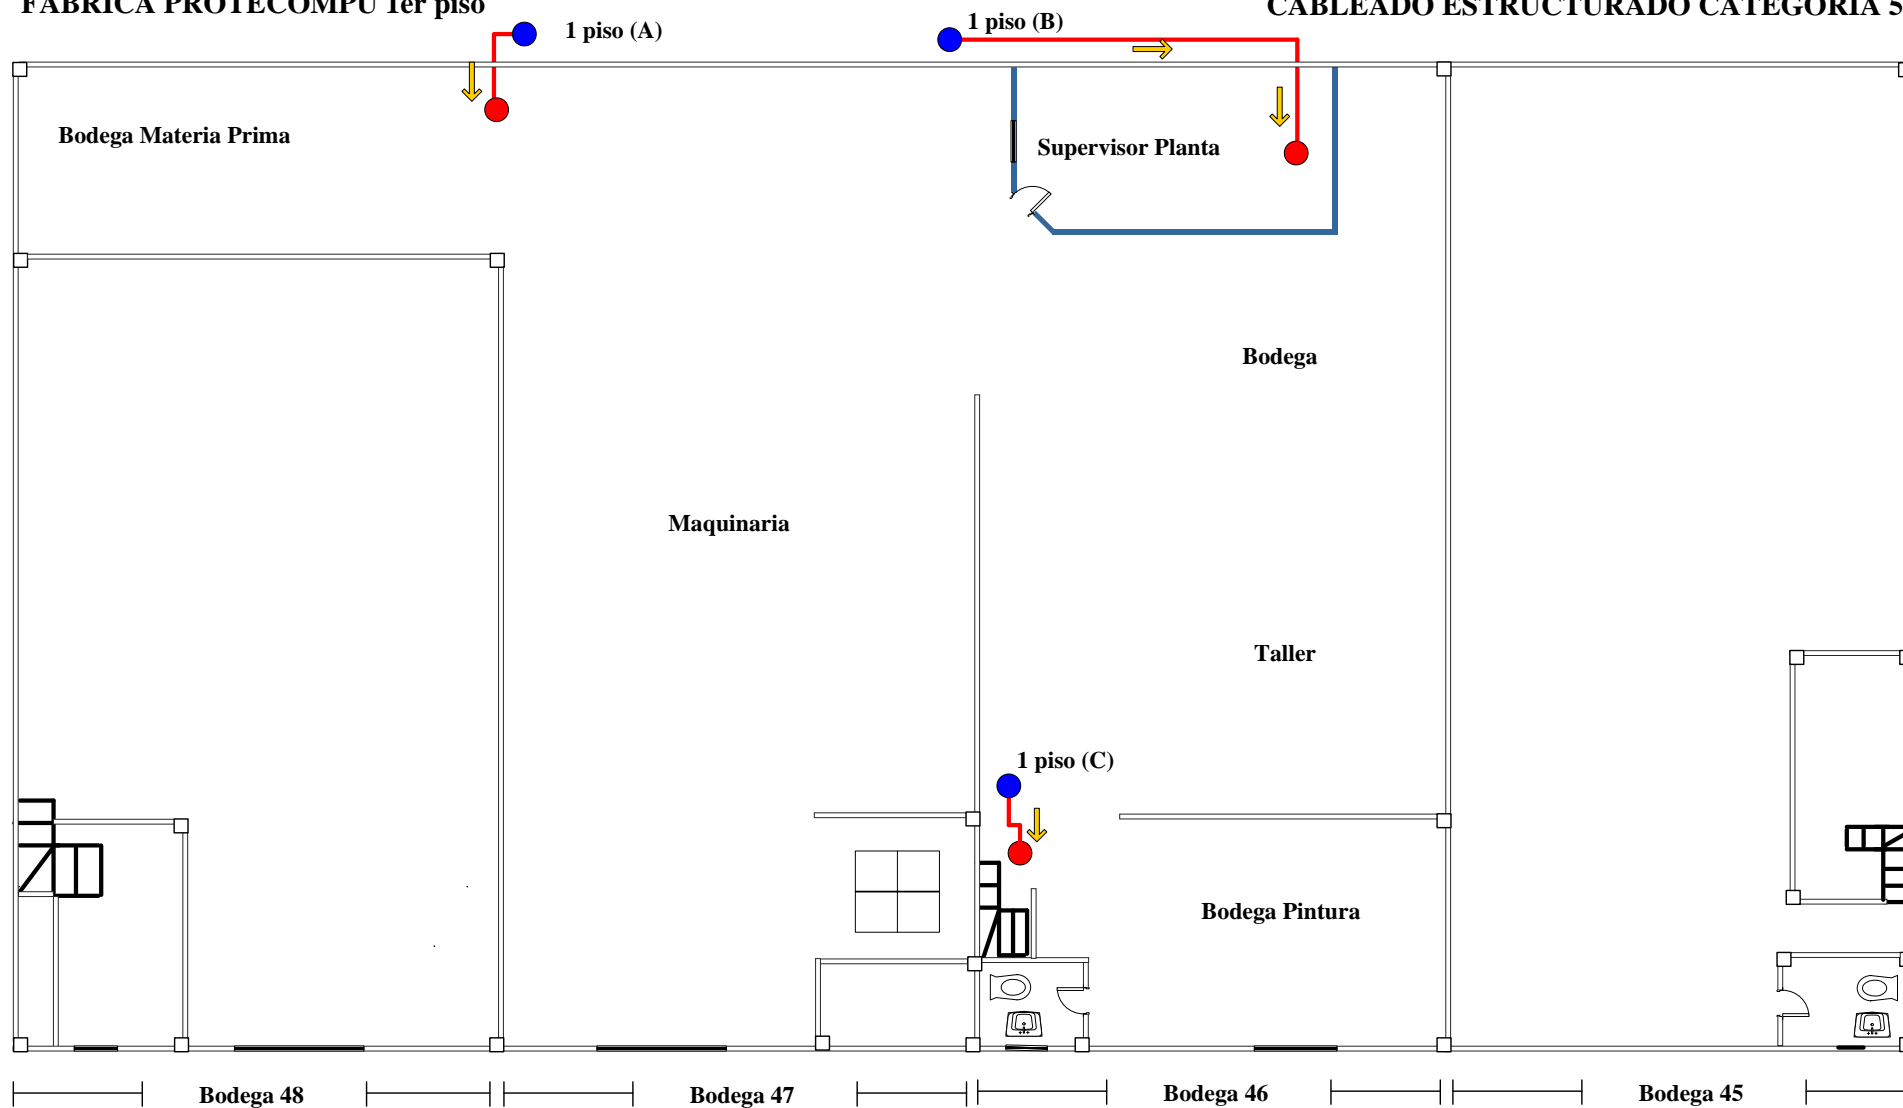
Planos del tendido del cableado estructurado primer piso
